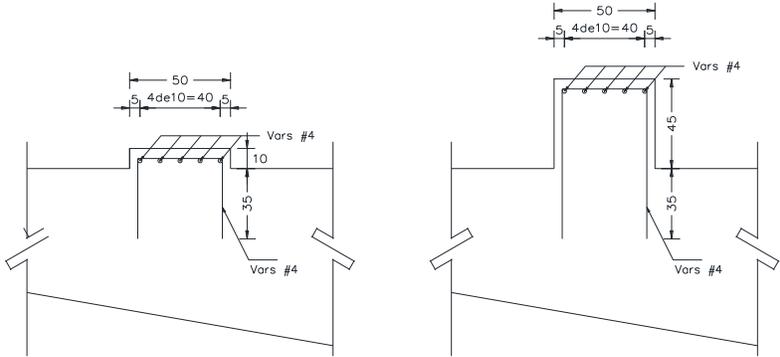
Vista en elevación de los bancos de nivel de la pila No. 4, con sus respectivos armados para unirse al cabezal.
